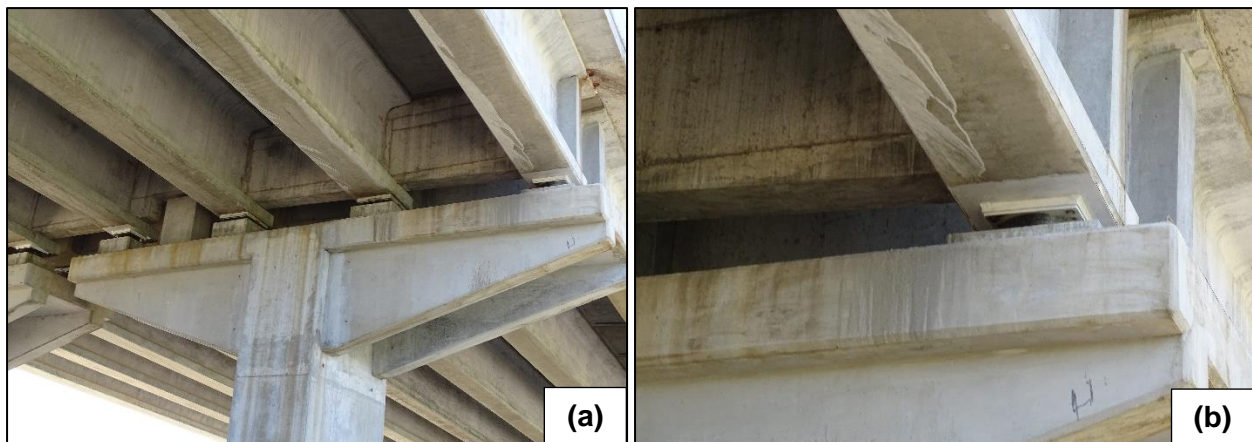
Pila del viaducto donde ya se aplicó un sistema de protección a las placas de acero de los apoyos.
